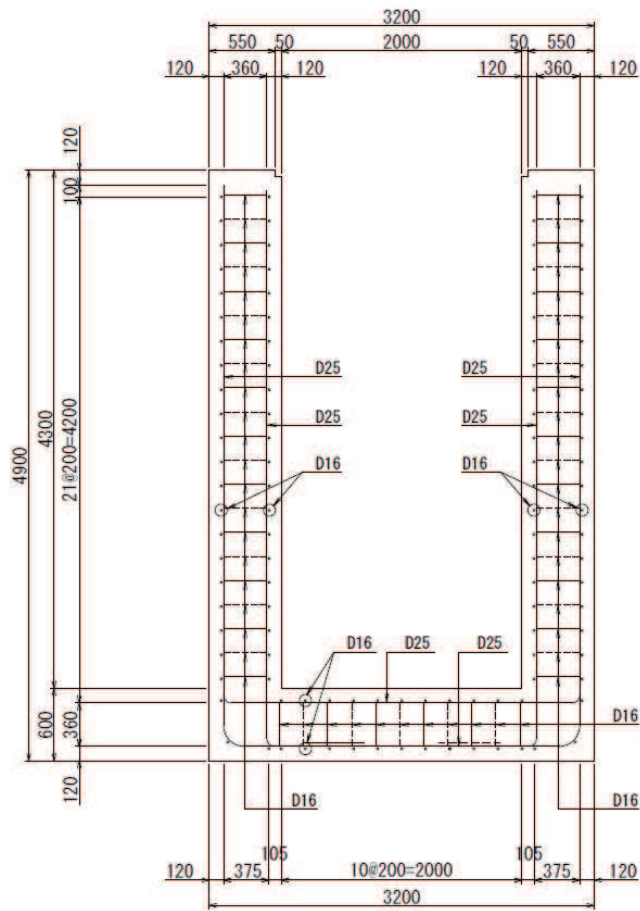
集水ピットの概略配筋図 (単位 : mm)
